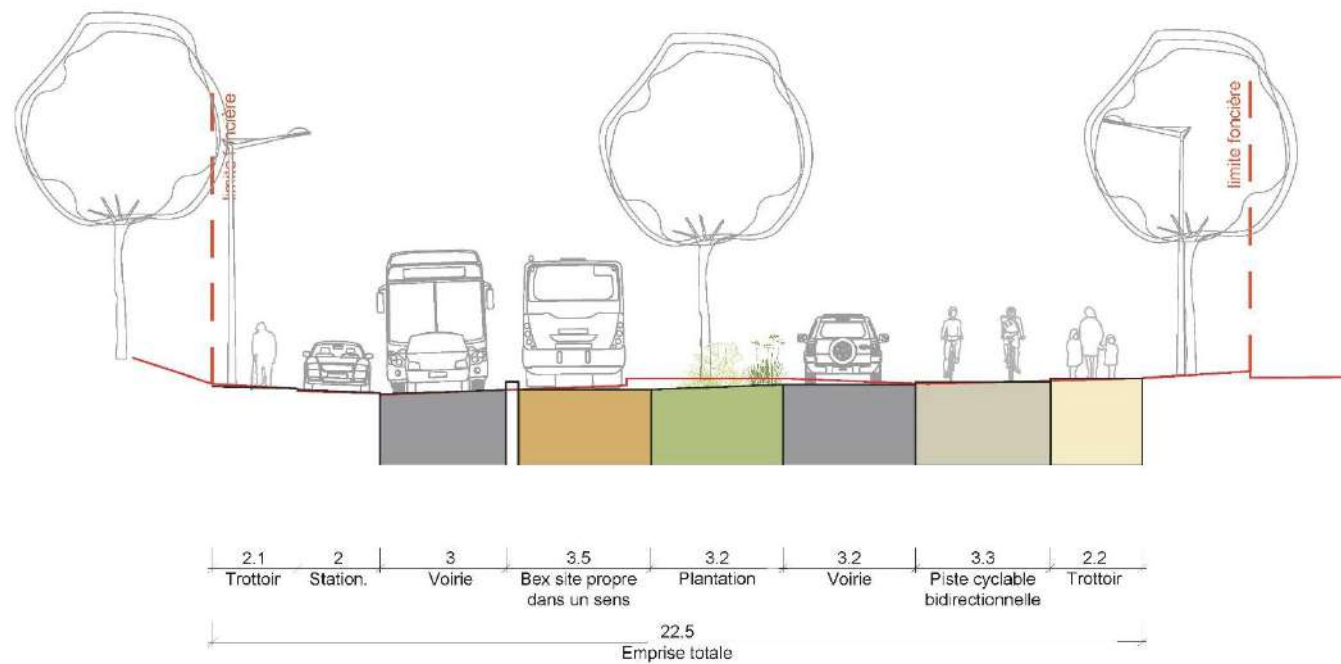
Coupe type sur la rue Arthur Rimbaud
